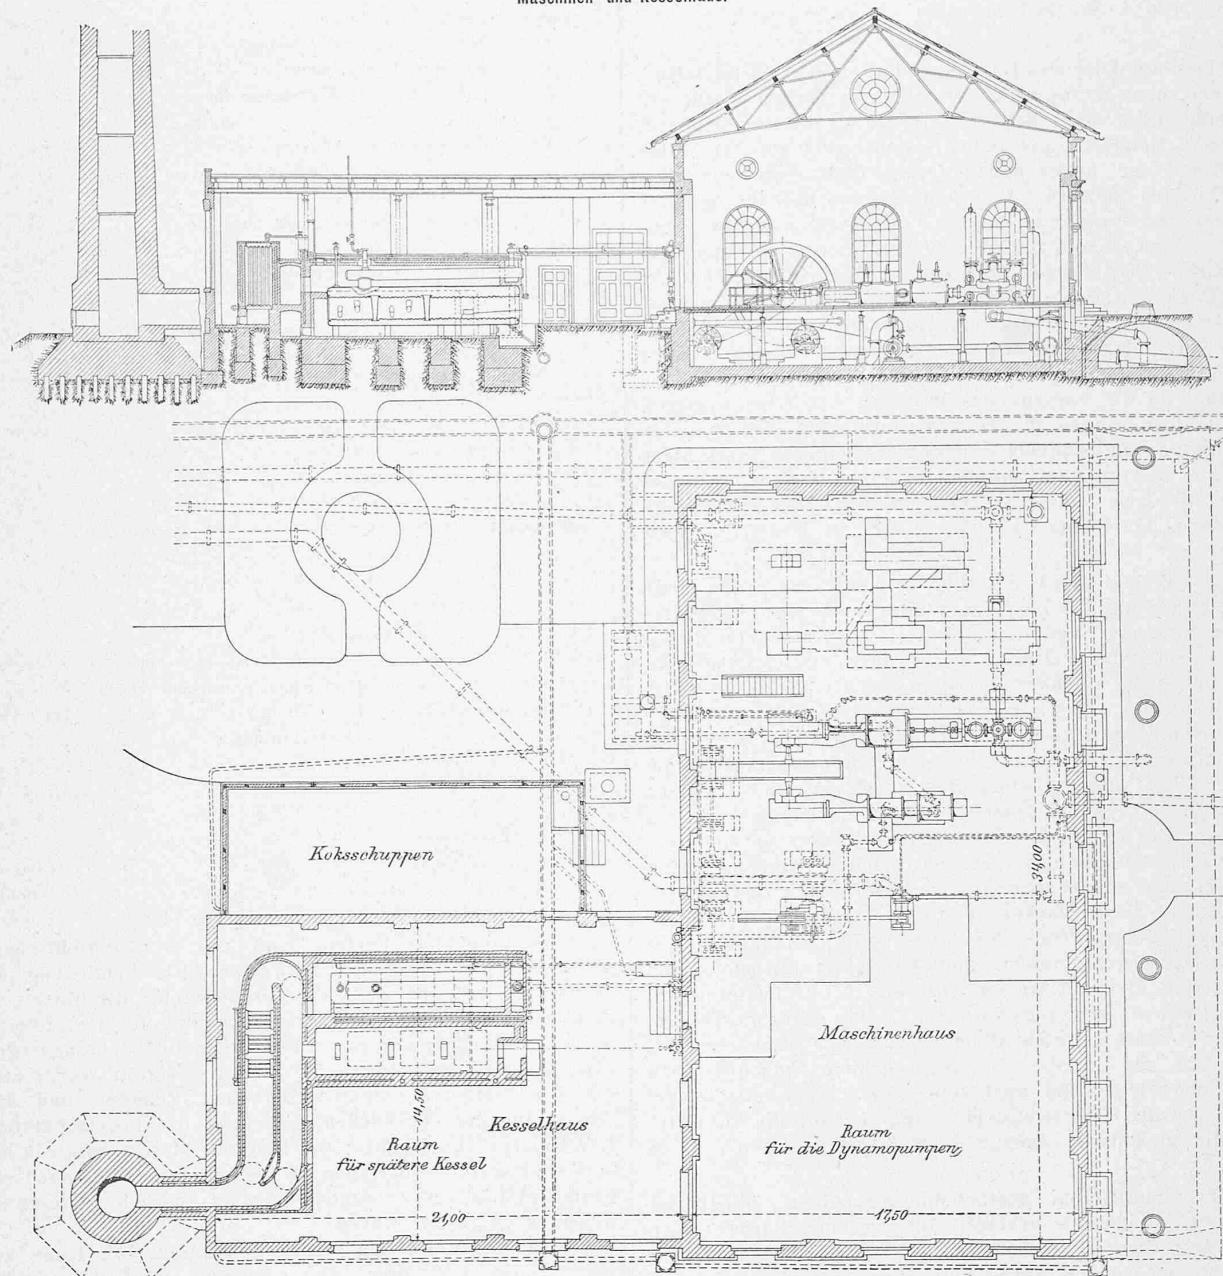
u. 2. Querschnitt und Grundriss; Maßstab 1 : 300.
